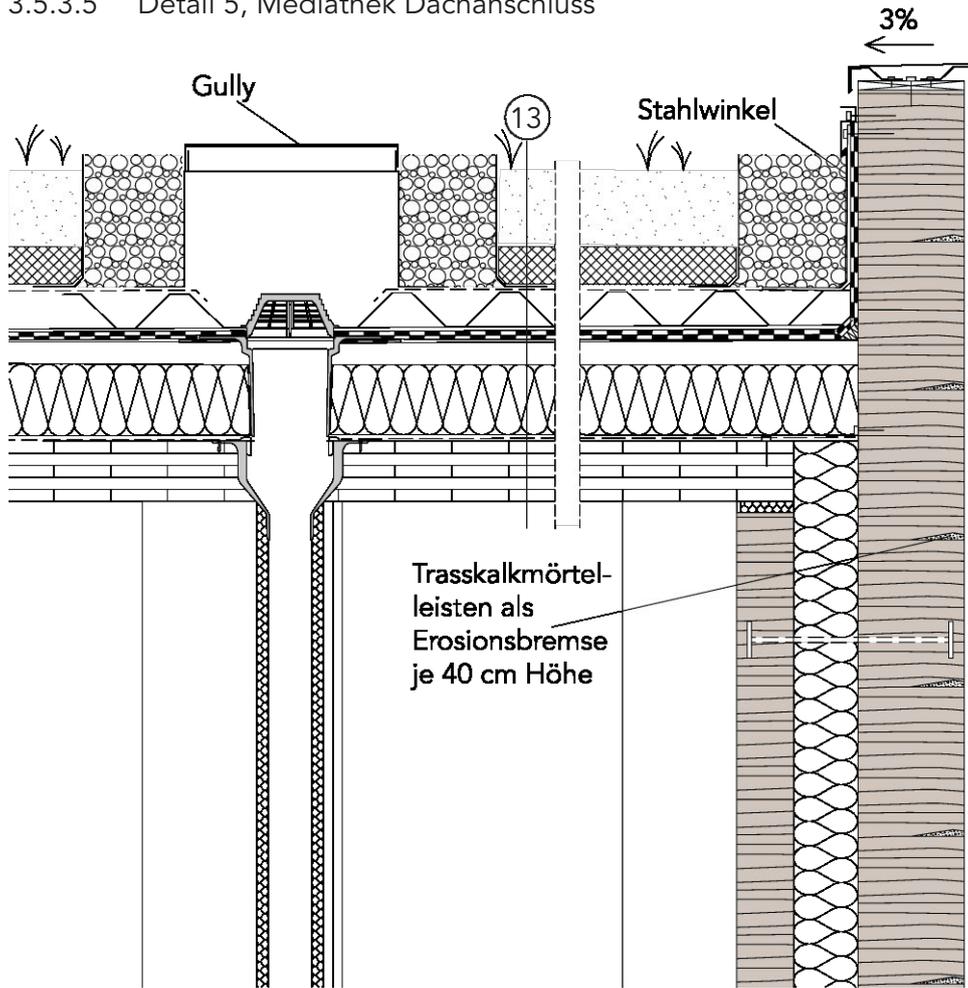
Konstruktionsdetail 5, Mediathek Dachanschluss
